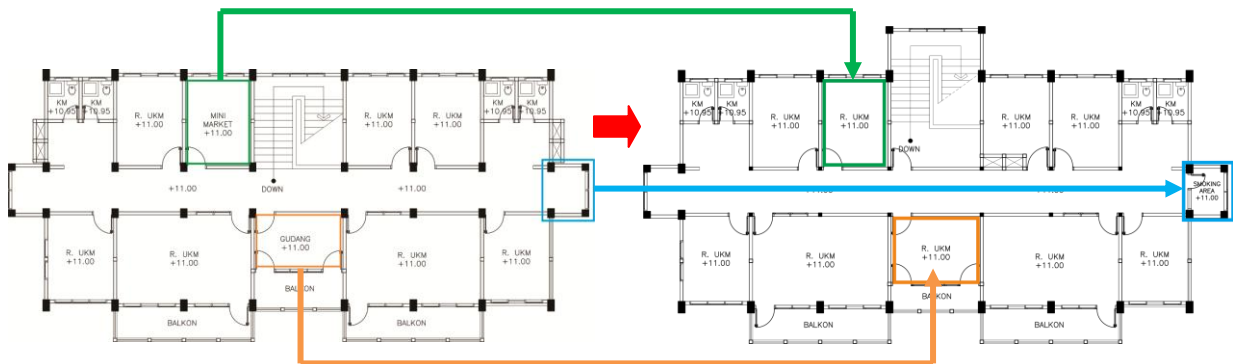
Denah Eksisting dan Rekomendasi Denah Lantai 1
